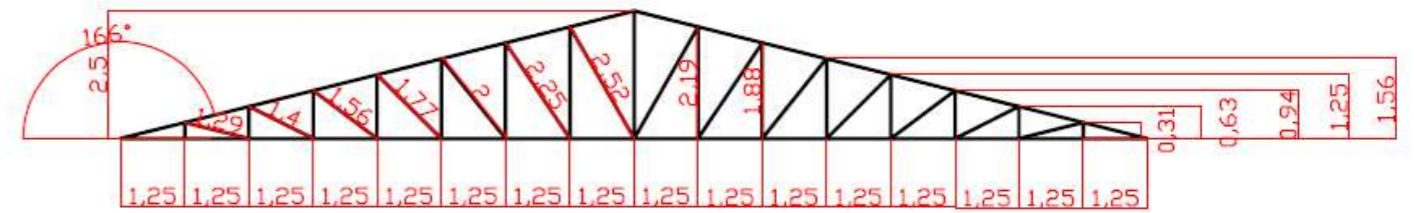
Figura 13. Imagen completa de la estructura que soporta la cubierta
